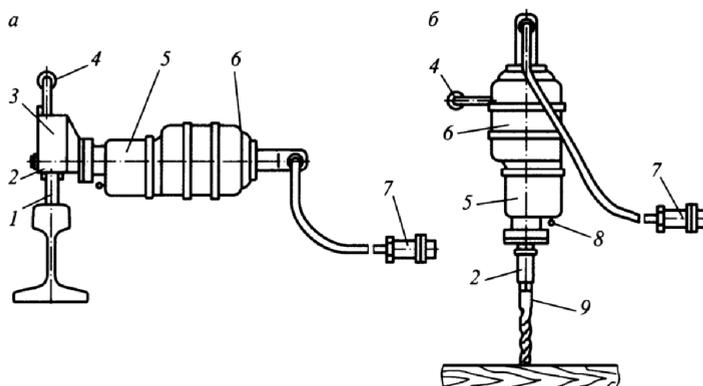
Сверлошлифовалка СШ1 при шлифовании головки рельса (а) и при сверлении шпалы (б): 1-шлифовальный круг; 2- шпиндель; 3-кожух; 4- рукоятка; 5- редуктор; 6 –электродвигатель; 7- кабельная вилка; 8 – переключатель скоростей; 9- сверло.
